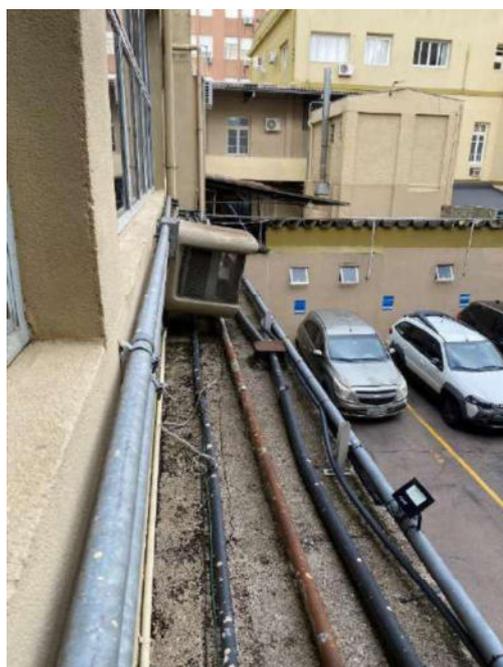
Marquise com presença de lodo e fissuras na impermeabilização
